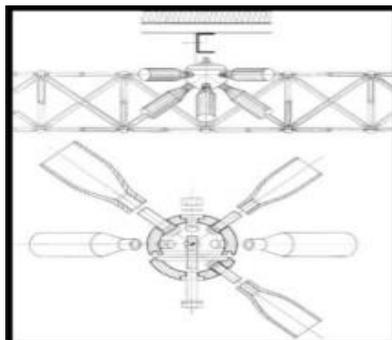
les poutres tridimensionnelles et la rotule de fixation
